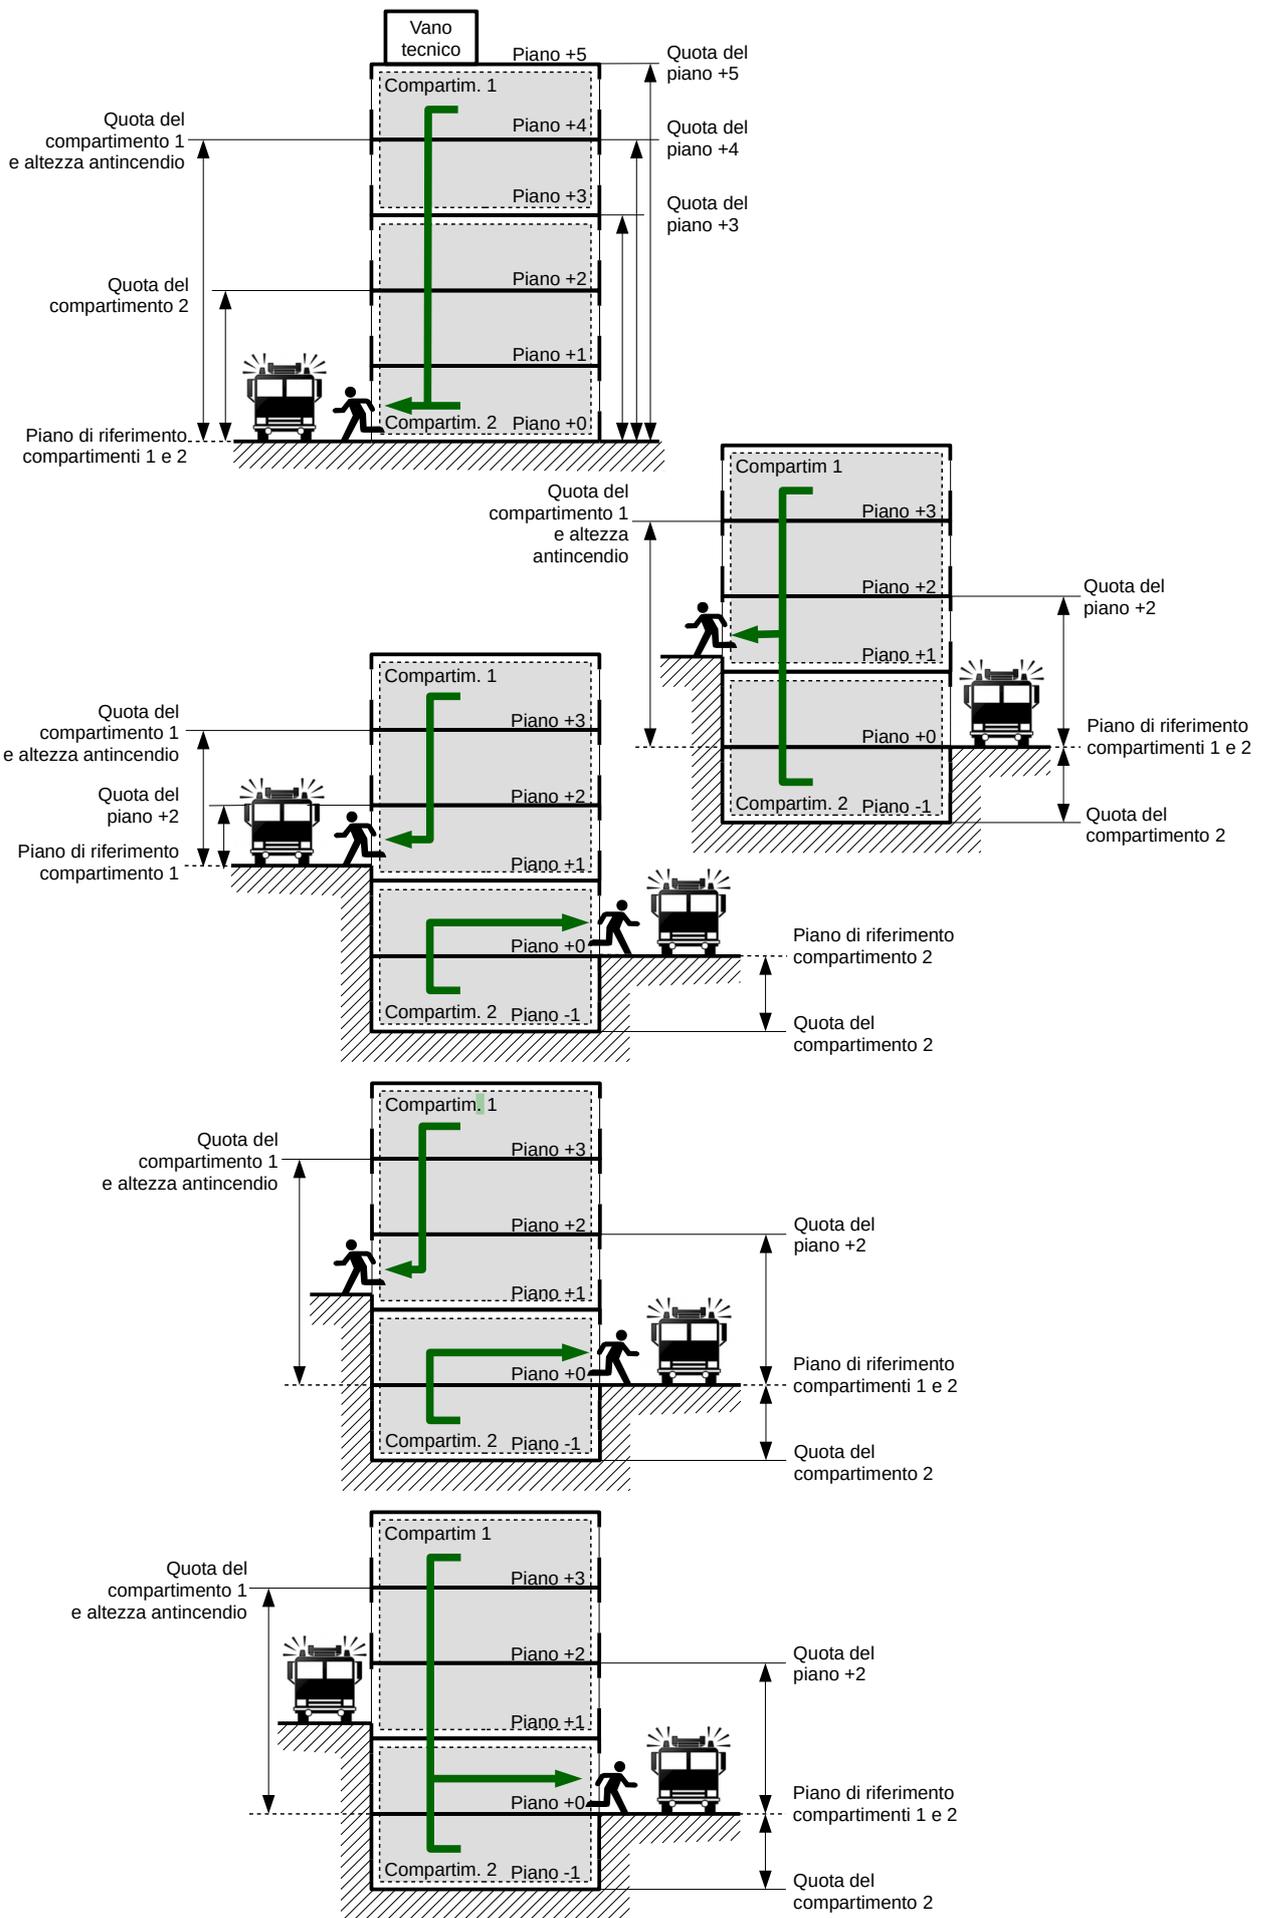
Esempi di altezza antincendio, quote di piano e di compartimento, in sezione
